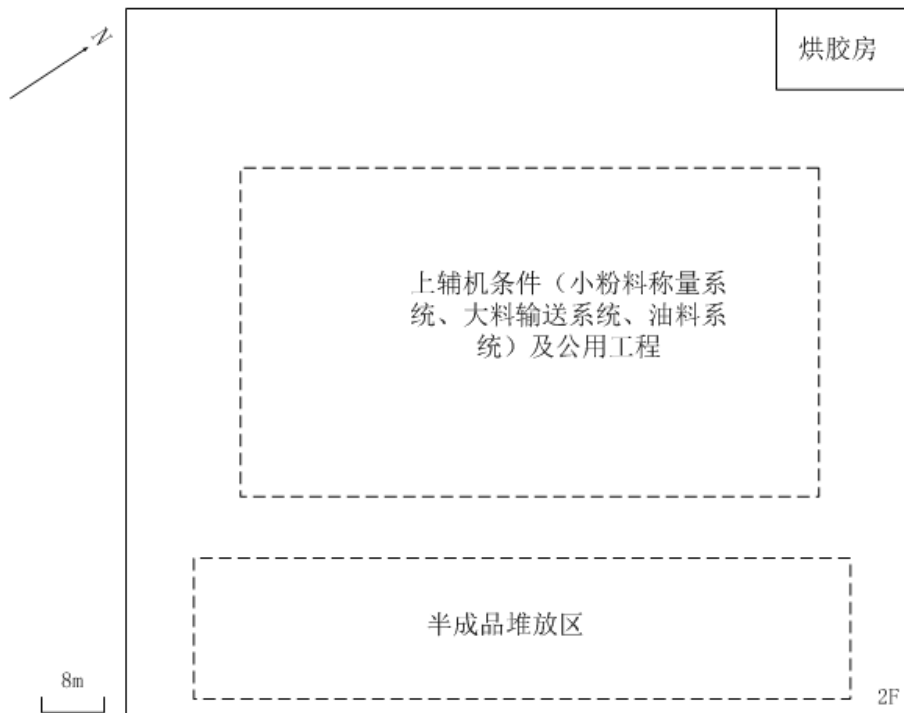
项目炼胶车间 2F 平面布置（变动前）
